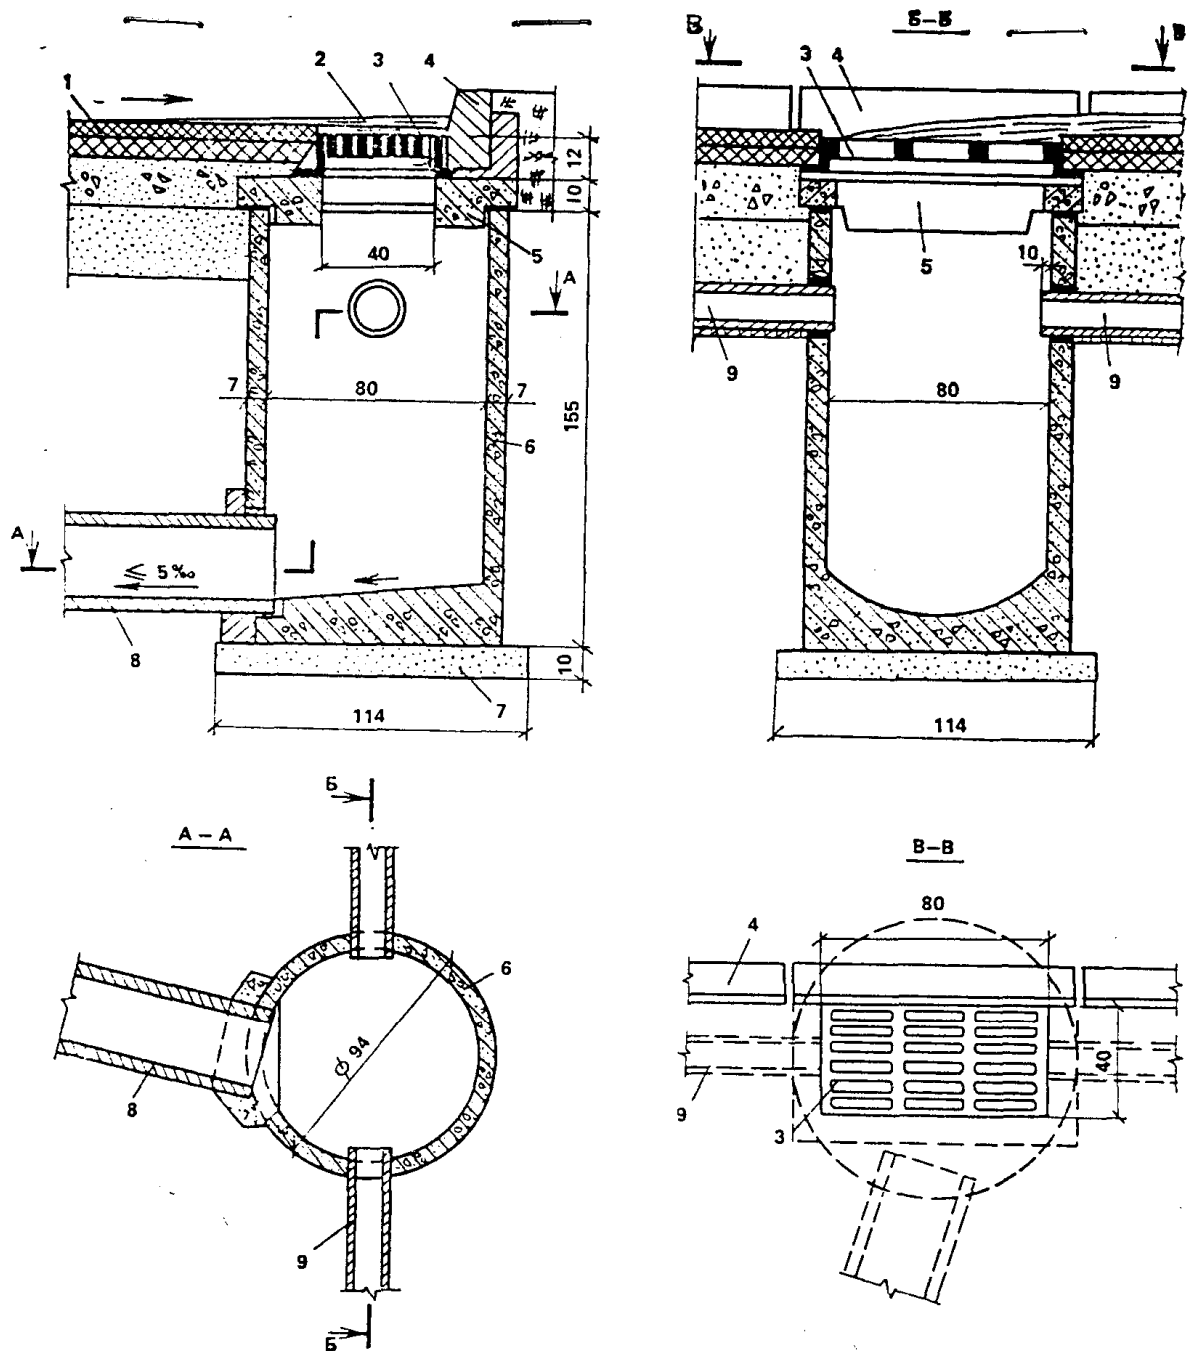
Сборный железобетонный дождеприемный колодец: 1 – дорожная одежда; 2 – лоток проезжей части; 3 – водоприемная решетка с люком; 4 – бортовой камень; 5 – плита перекрытия; 6 – рабочая камера с дном и лотком; 7 – песчаное основание; 8 – водосточная ветка; 9 – дренажные трубы
